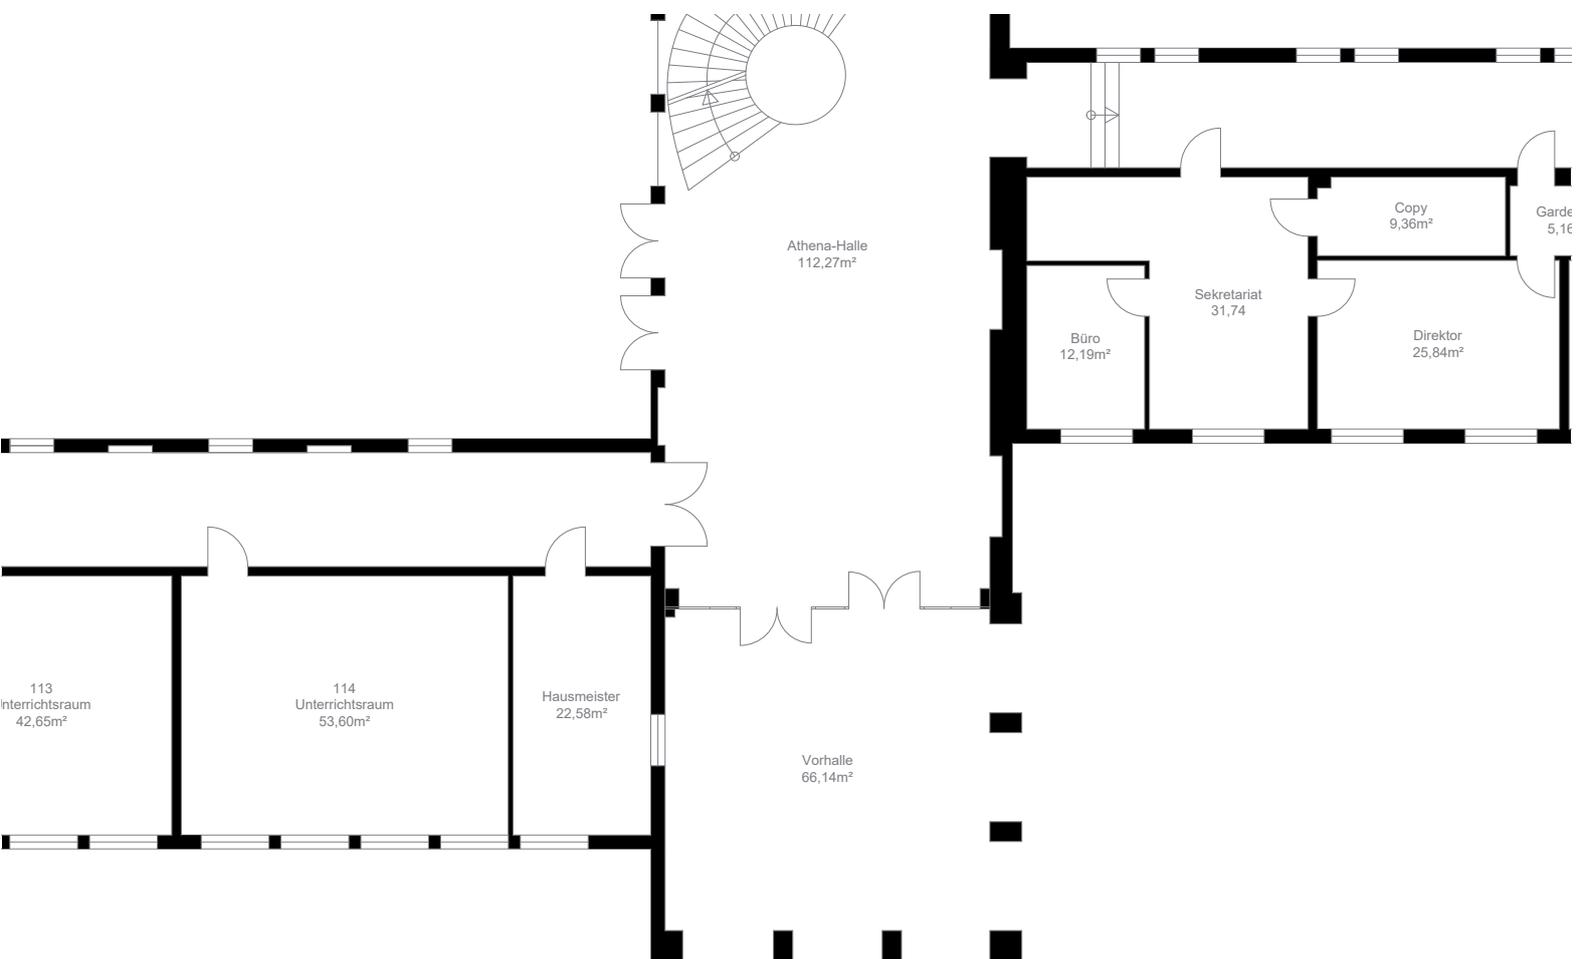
Grundrisszeichnung Ausschnitt Hauptgebäude ohne Maßstab
